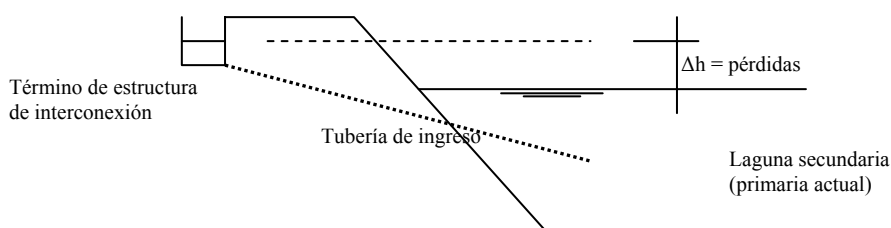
c. DETALLE C: Entrada a laguna primaria (anaerobia proyectada).
